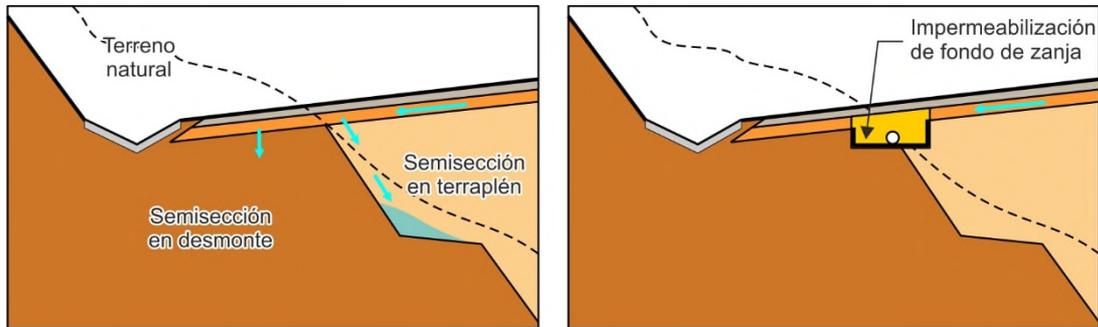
Caso de zanja longitudinal en la transición de una sección transversal a media ladera. Se dispuso lámina de impermeabilización como fondo de zanja.
